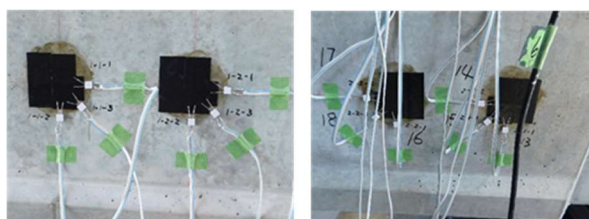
せん断試験体 WEB 面の三軸ゲージ貼付状況
